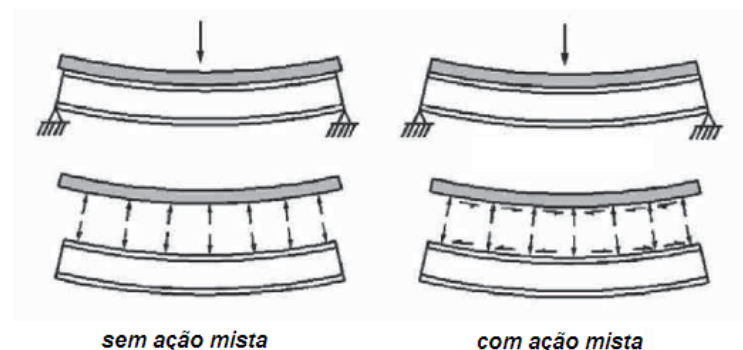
Transferência de esforço cortante da laje de concreto para a viga de aço define a ação mista na estrutura.
